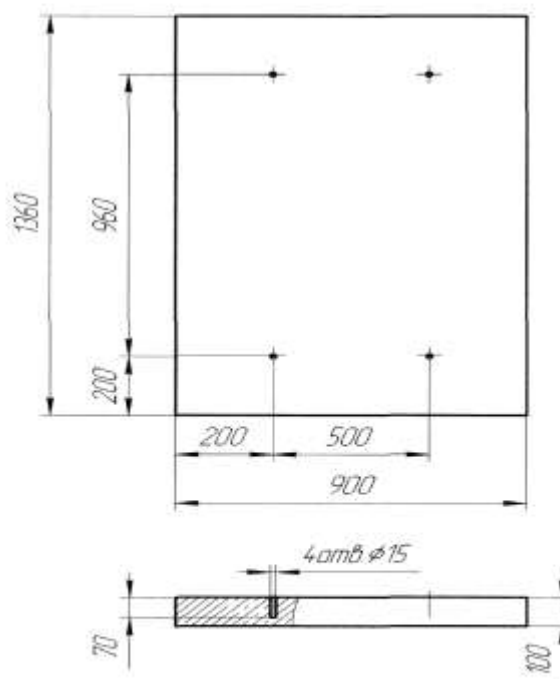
Окончательная схема фундаментной площадки подъемника АВ-24
